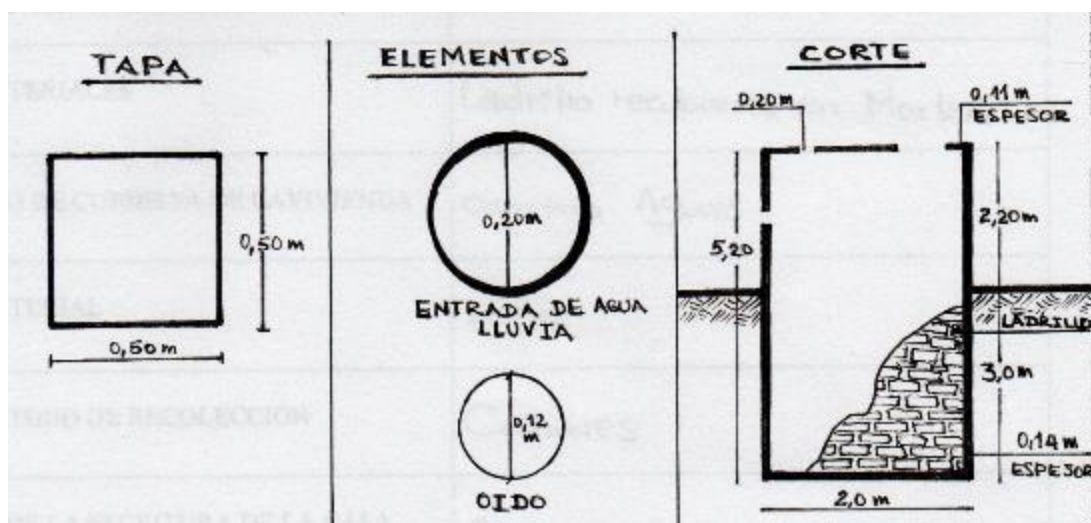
Detalles y Corte de Elementos del Objeto Arquitectónico Familia Atencia
